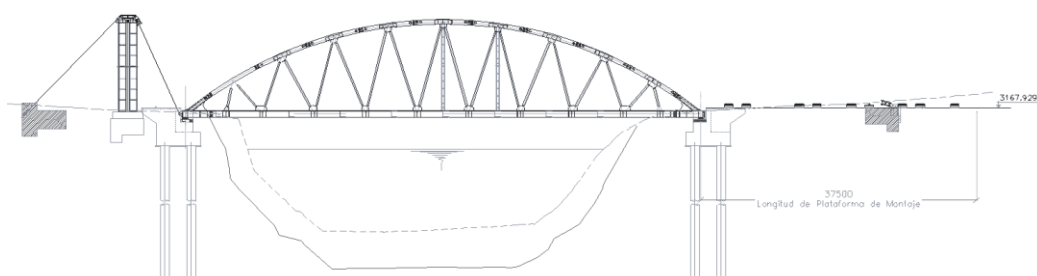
Montaje y Lanzamiento Puente Chupuro – Etapa 9
